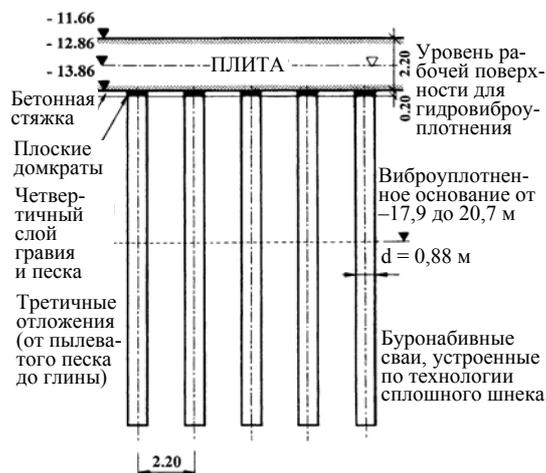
Схема плитно-свайного фундамента башни Миллениум со схемой установки плоских домкратов и указанием зон местного виброуплотнения
